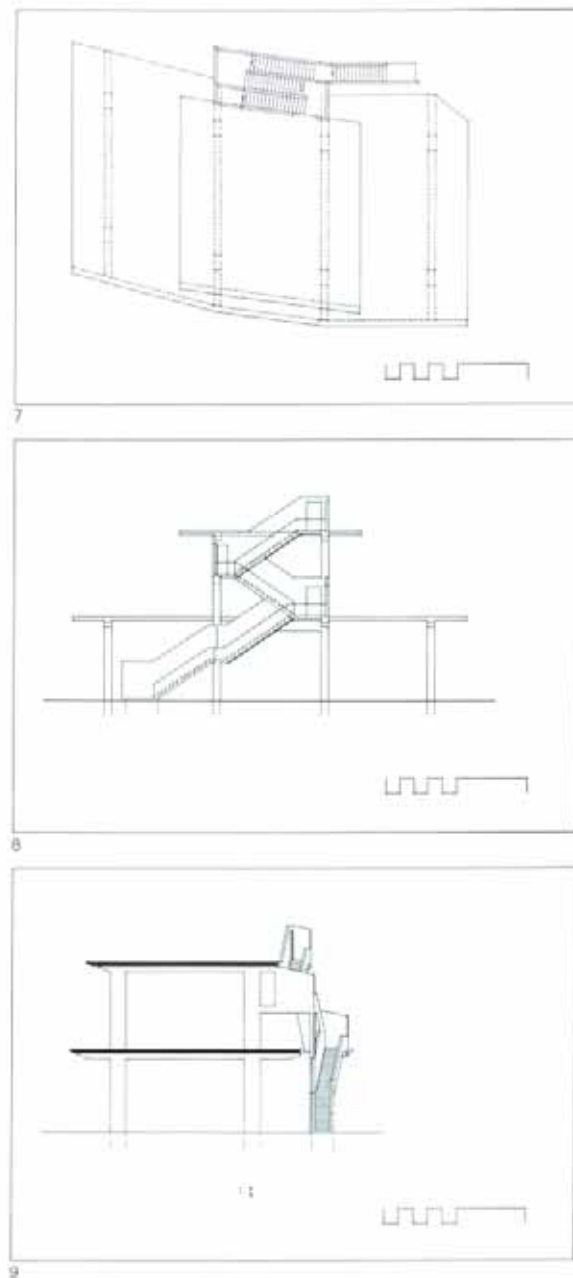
Grundriss, Ansicht und Schnitt eines leeren «Garten-Gestells»
